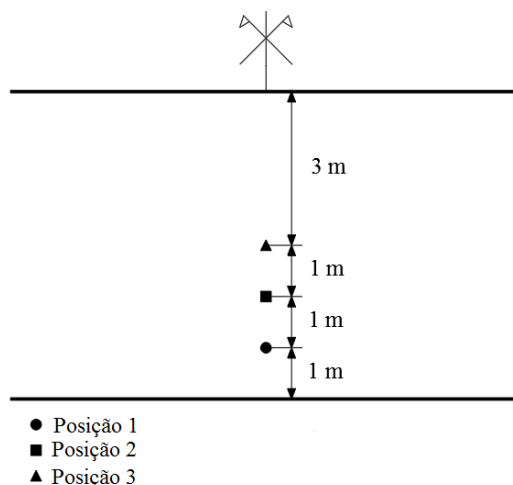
Vista em planta do tabuleiro da ponte e dos pontos de aplicação da carga.
